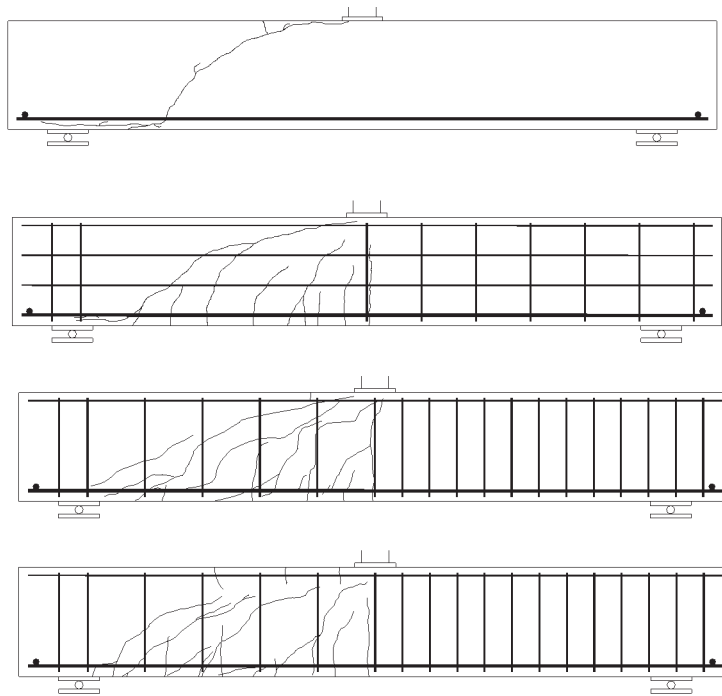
Fisuración en rotura típica para las vigas ensayadas. a) Vigas sin armadura a cortante. b) Vigas con armadura longitudinal distribuida en el alma. c) Vigas con armadura a cortante. d) Viga H60/3 –las fisuras de cortante no cruzaron la cabeza comprimida de la viga.
